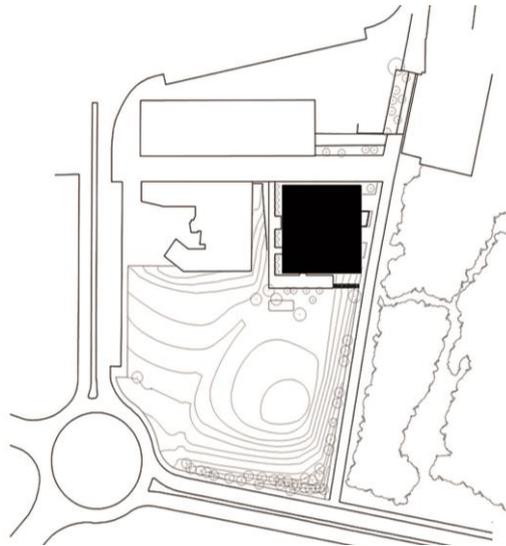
Plano de ubicación. Fuente: Archdaily, 2014. Elaboración: imagen de cortesía de DATAAE y H Arquitectes (2014). Archdaily.
